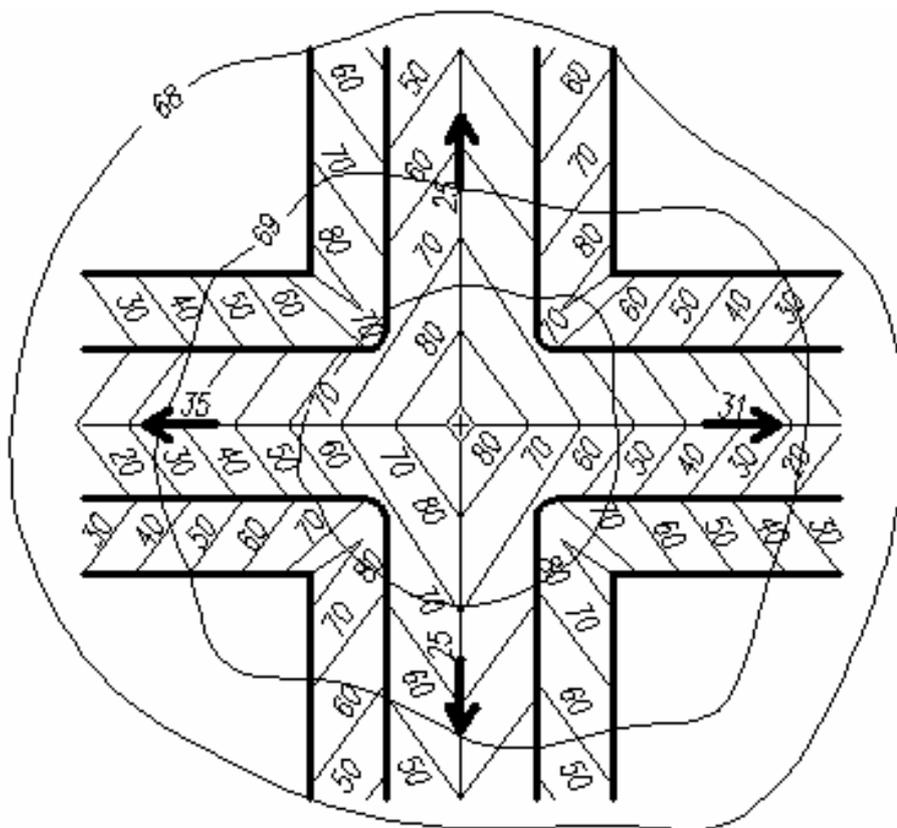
Вертикальная планировка перекрестка, расположенного на горе
